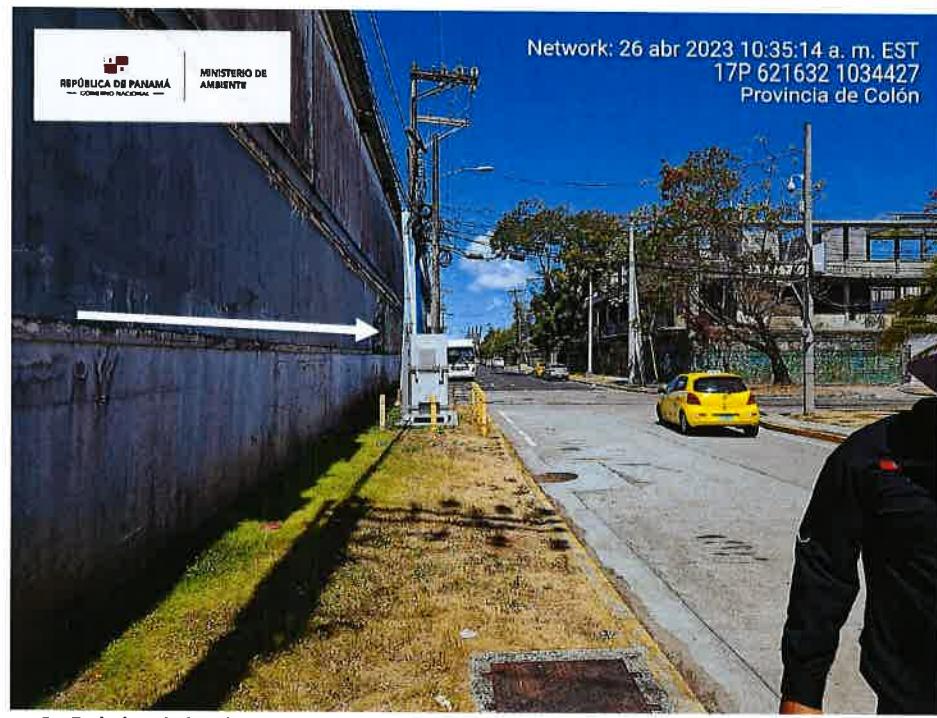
Inicio del alineamiento a lo largo de la Calle 13, donde se harán trabajos de pintura sobre el muro existente.
